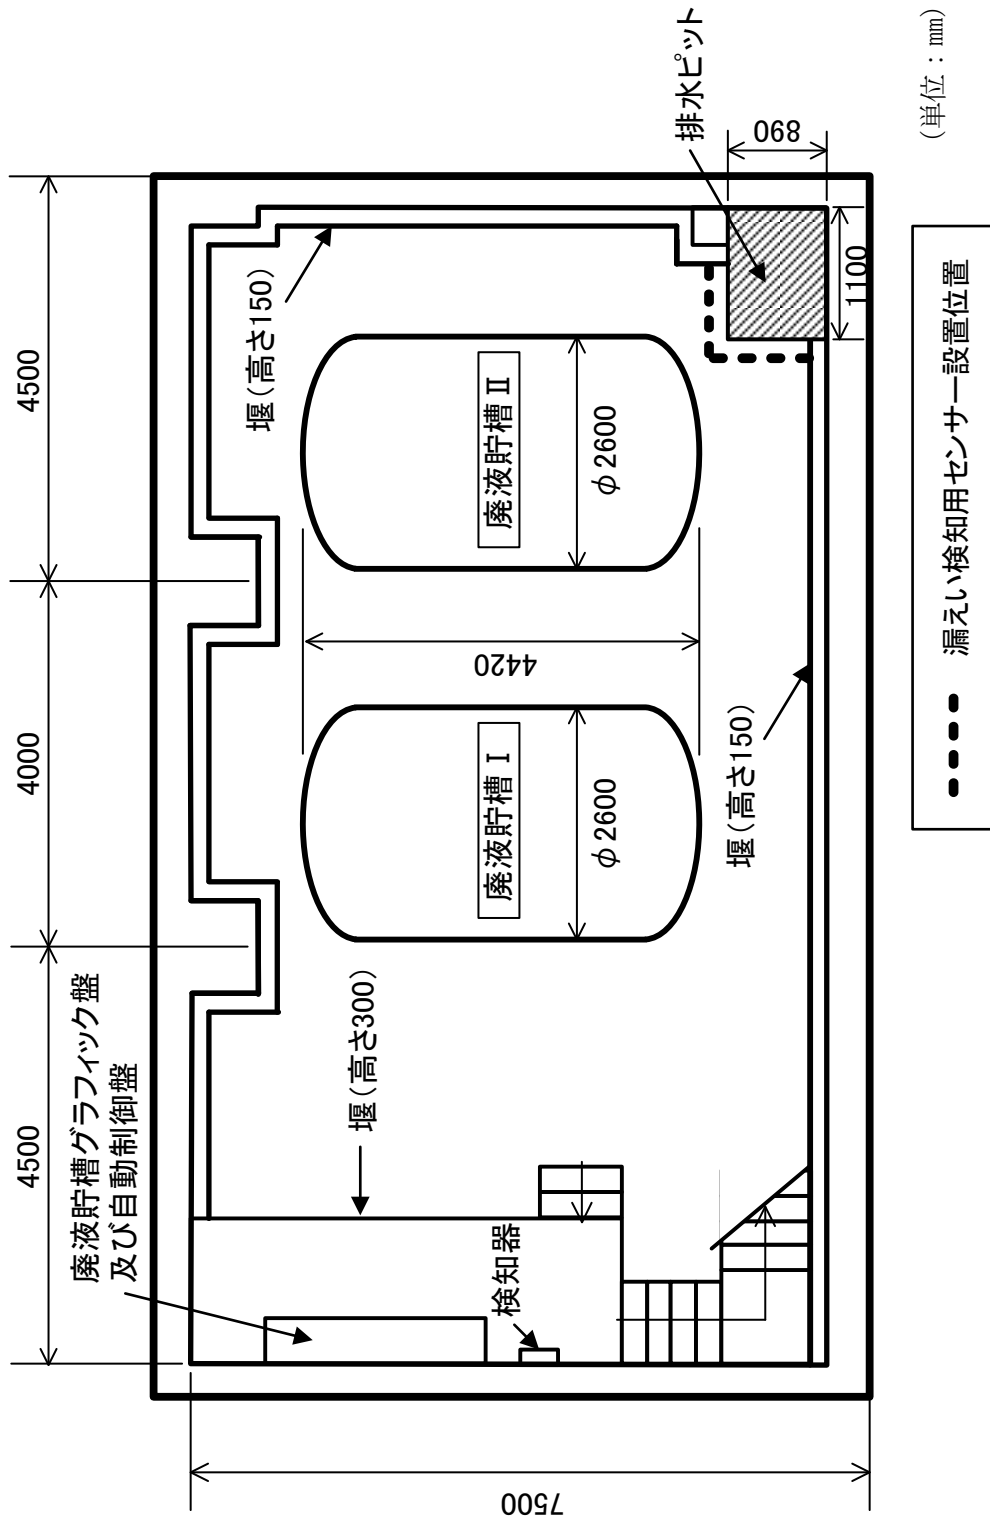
廃液貯槽の漏えい検知器の配置図 (その2)
